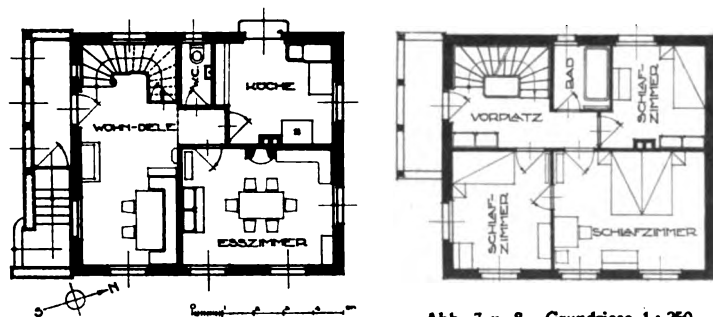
u. 8. Grundrisse 1:250.
